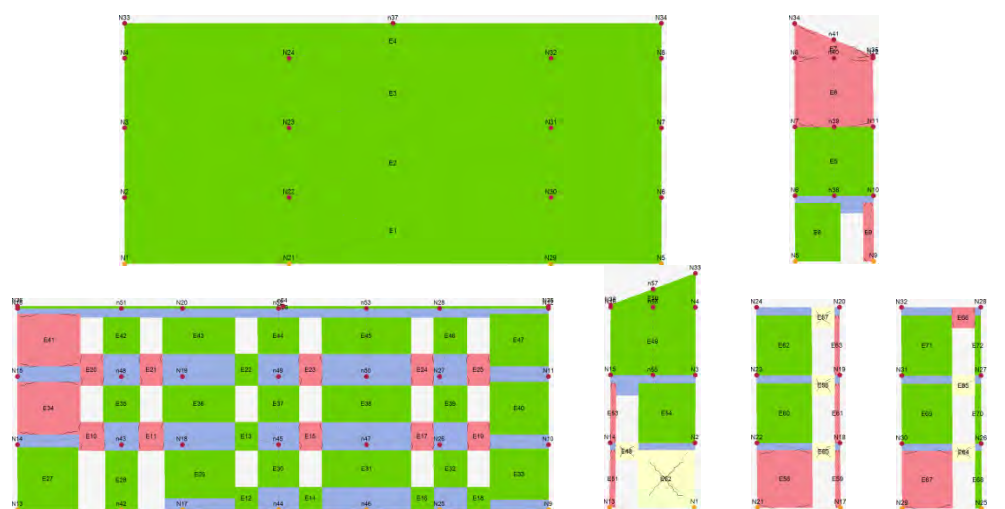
Rappresentazioni delle pareti, rispettivamente da in alto a sinistra: parete 1, parete 2, parete 3, parete 4, parete 5 e parete 6.
